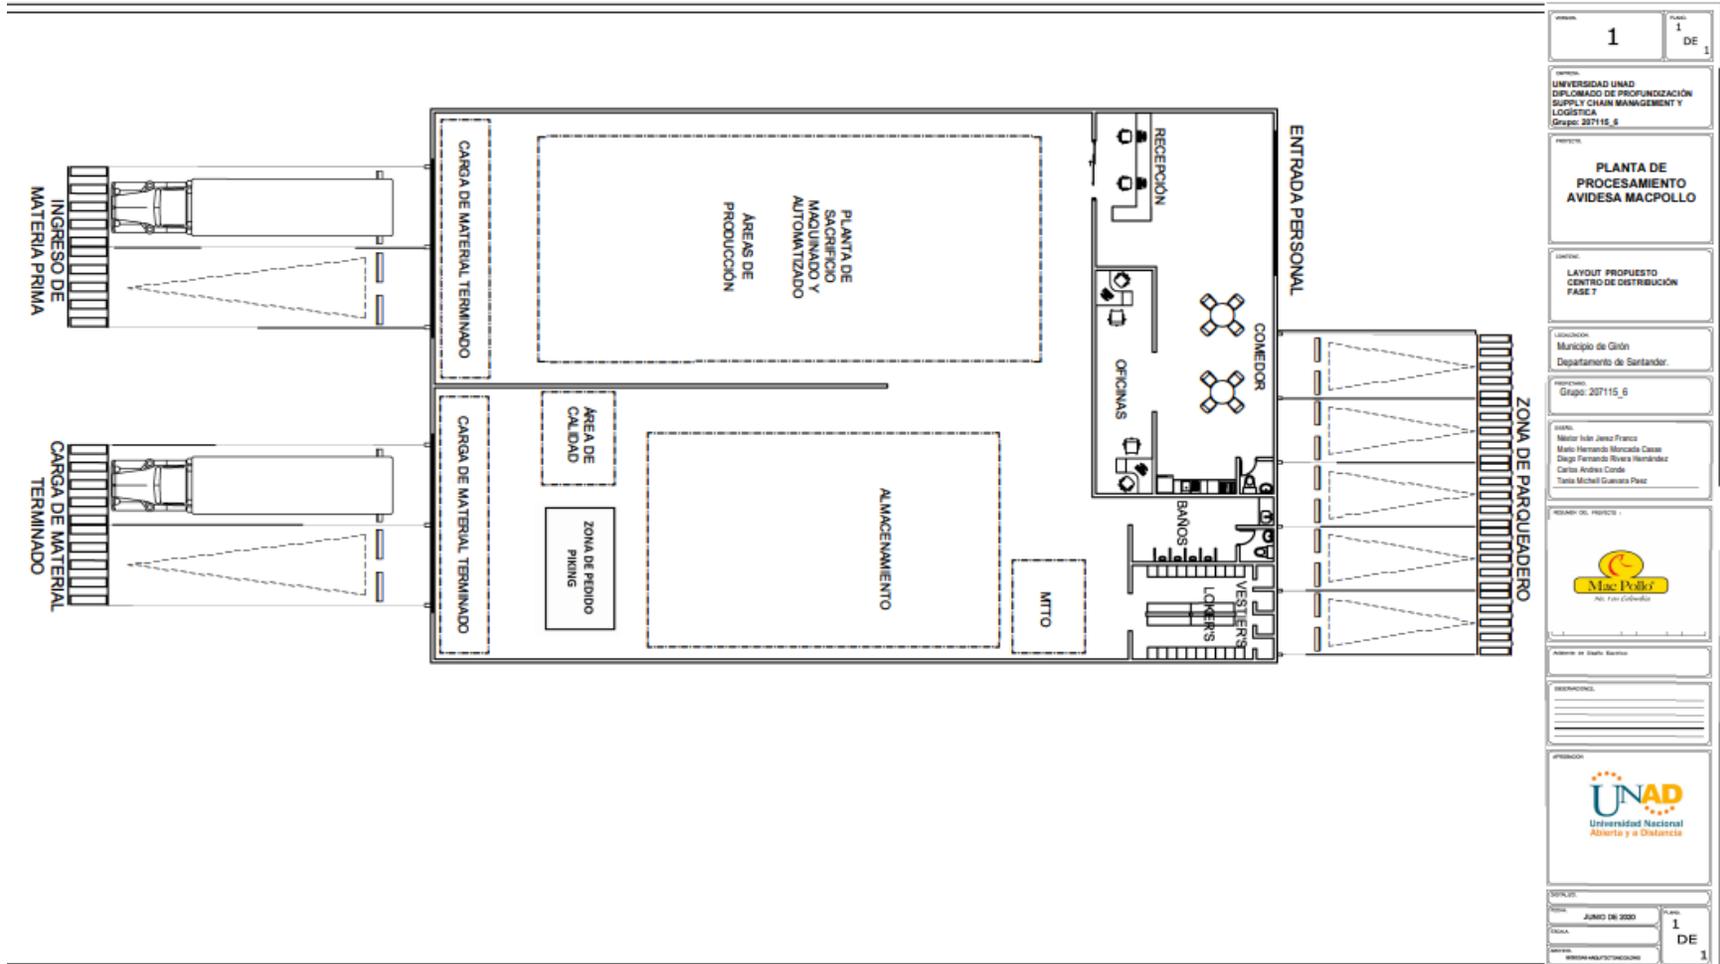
Layout propuesto para el mejoramiento de la planta autoría propia
